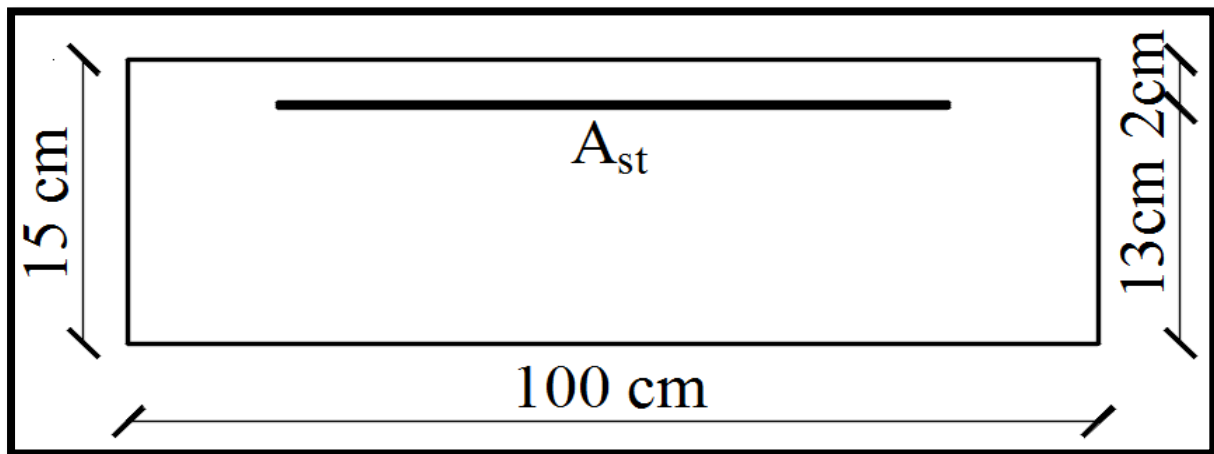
Schématisation (2D) de la section transversale du balcon.
